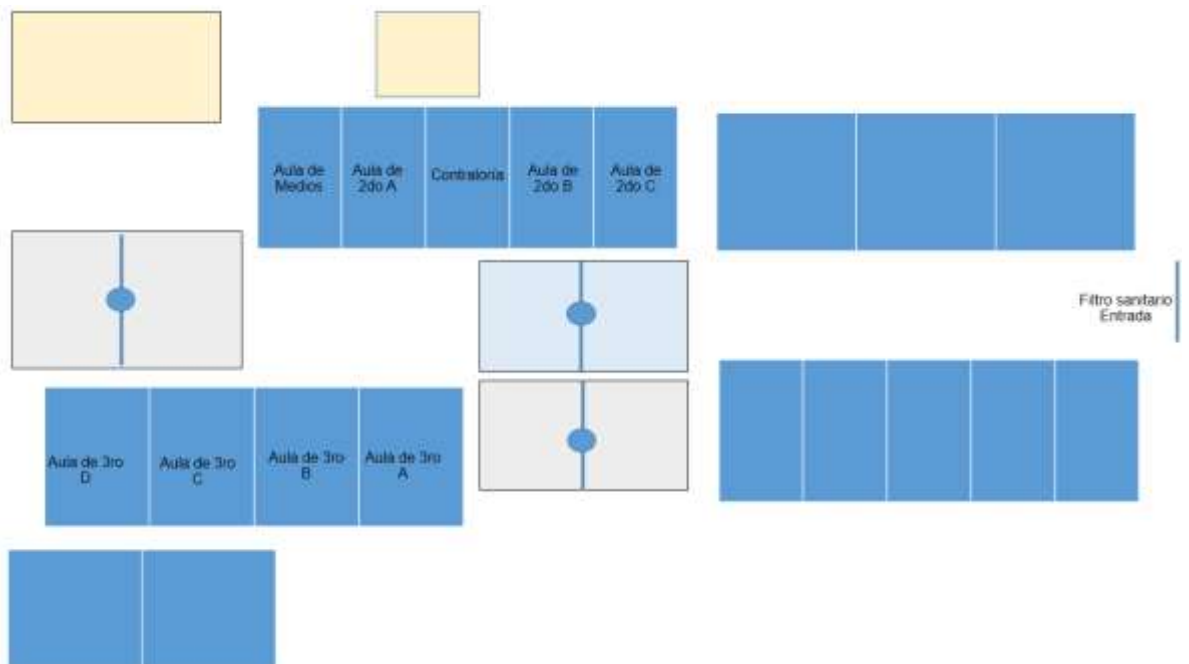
Plano de la “Esc. Sec. General No. 7, Antonio Díaz Soto y Gama” planta baja
